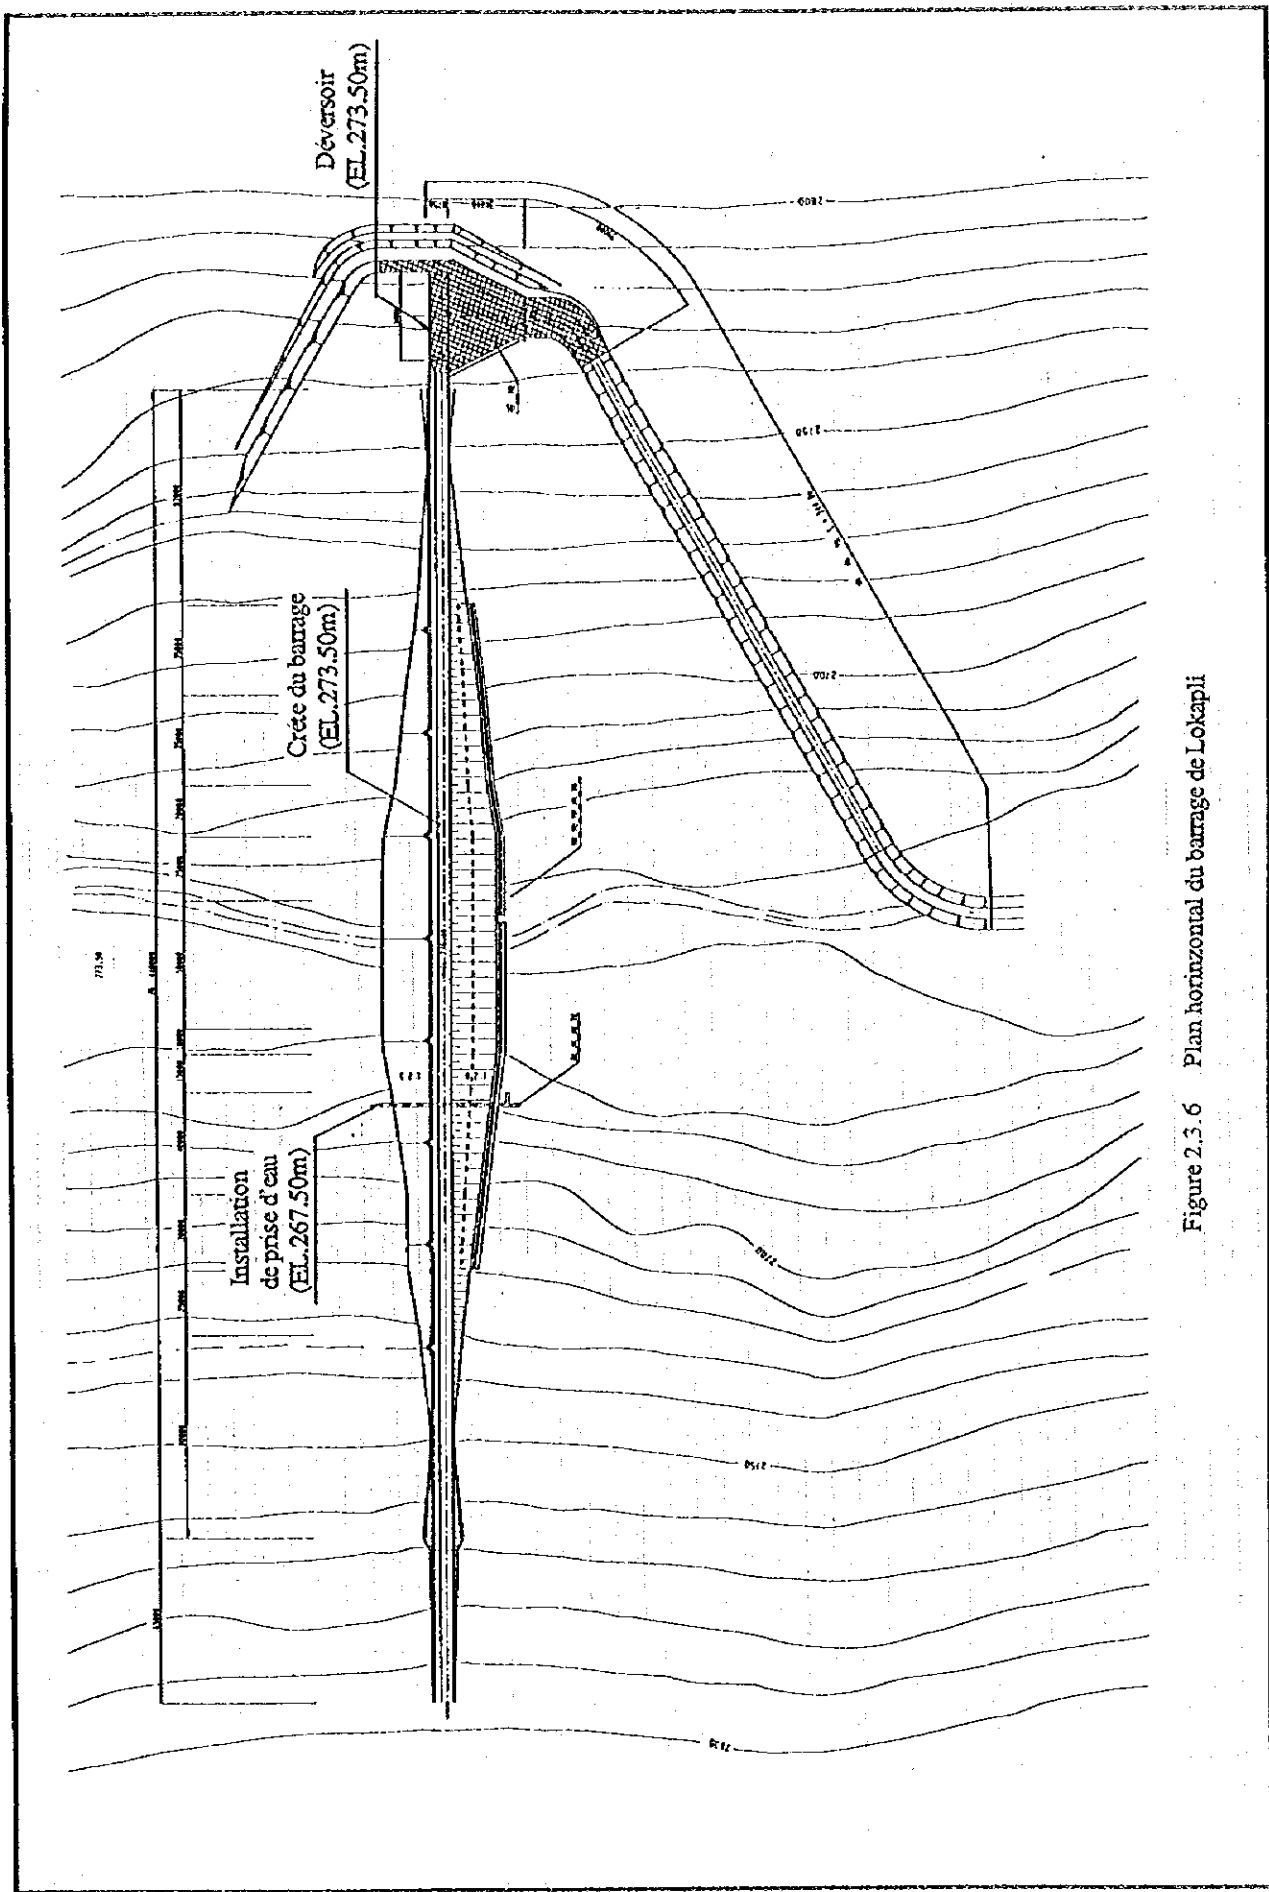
Plan horizontal du barrage de Lokapli
